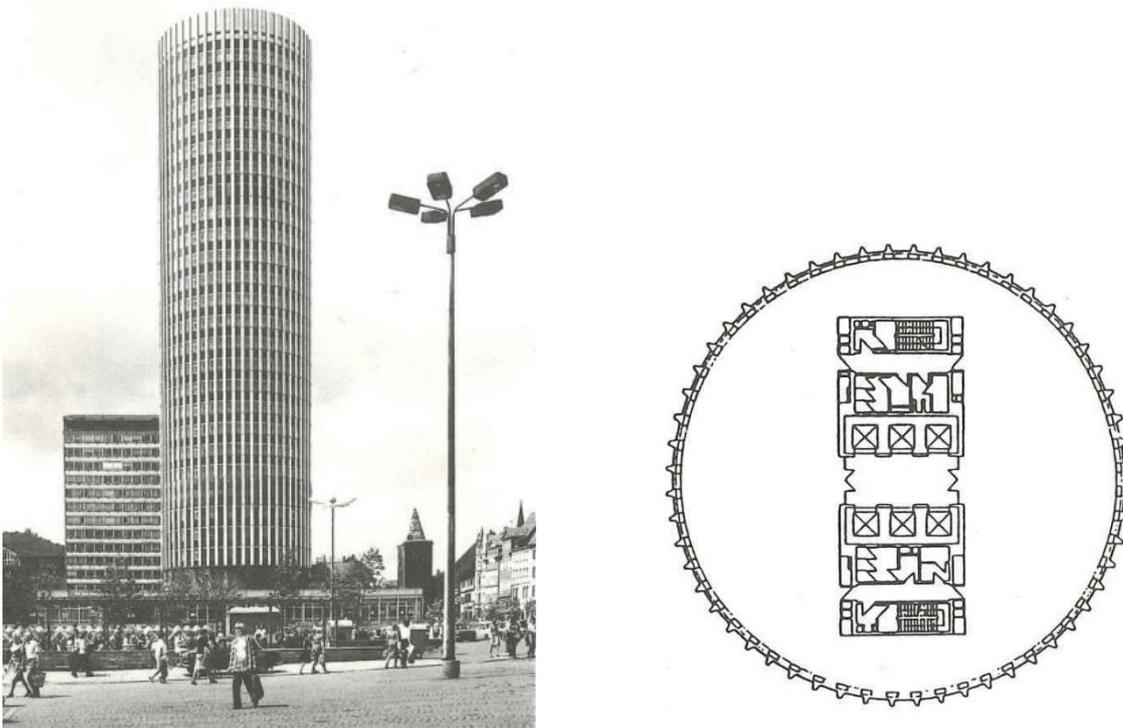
Jentower Ansicht 1982 und Grundriss
